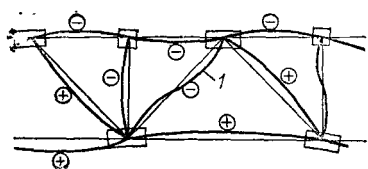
Схема деформации стержней при потере устойчивости сжатия стержнем
